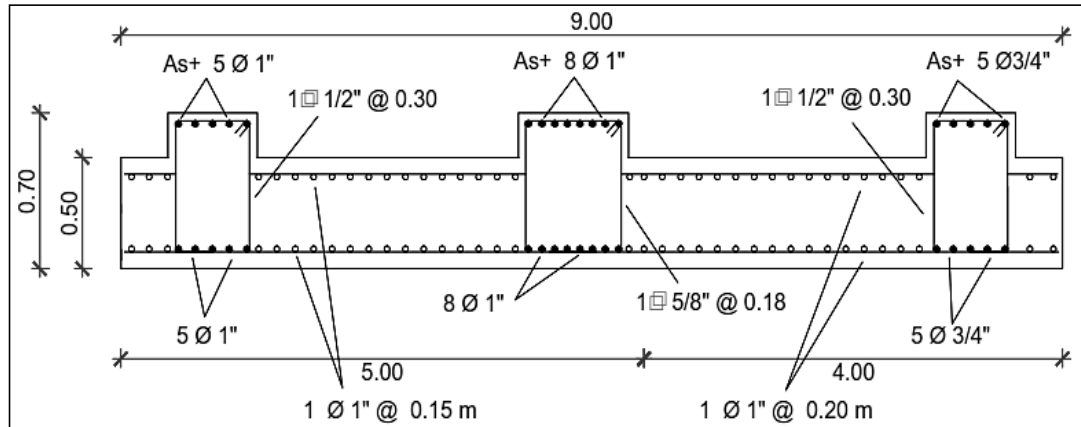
Detalle de acero longitudinal en vigas de cimentación
